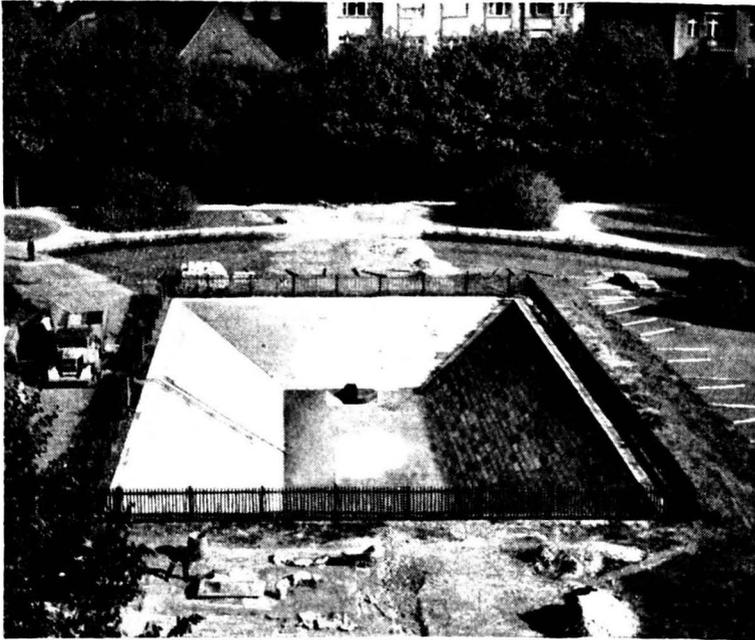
Feuerlöschteich mit schrägen Wandungen. Fassungsvermögen: 1200 m<sup>3</sup>. Untere Schale aus 8 cm starkem magerem Beton, darüber 3 Lagen Dachpappe mit Klebemasse als Dichtung, Schutzschicht aus 8 cm starken Betonplatten.
